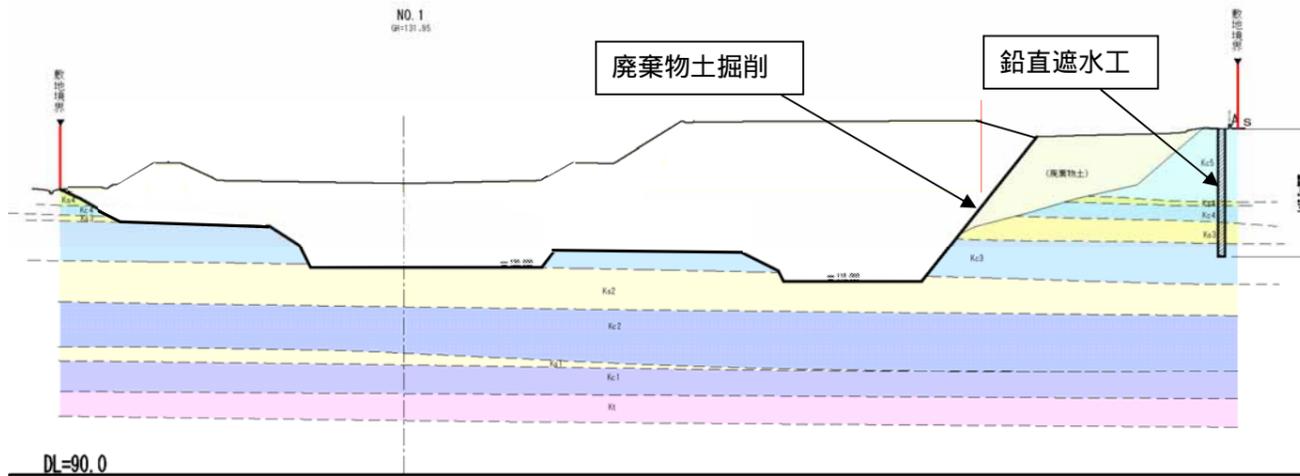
(1) 底面粘性土修復工および側面遮水工の施工方法（現況 掘削）
